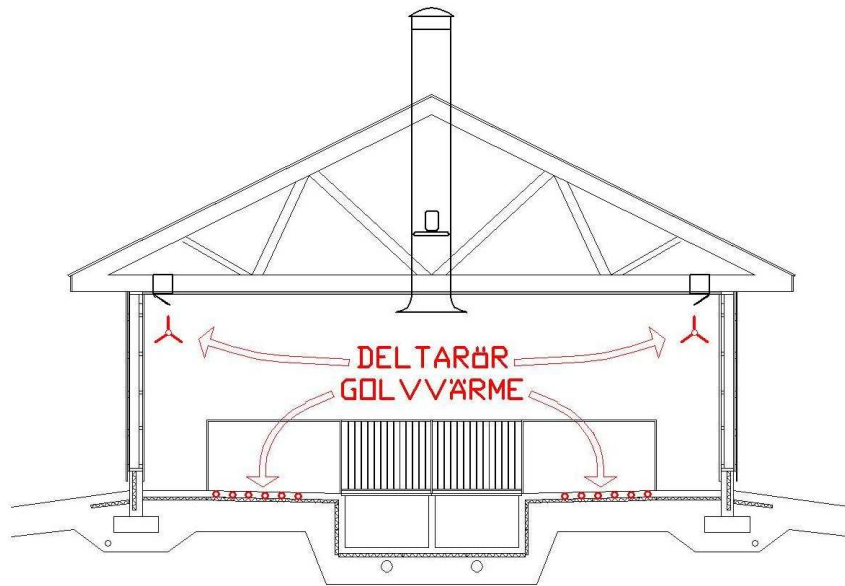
Skiss över värmerörens och elementens placering i äldre slaktsvinsstall.
